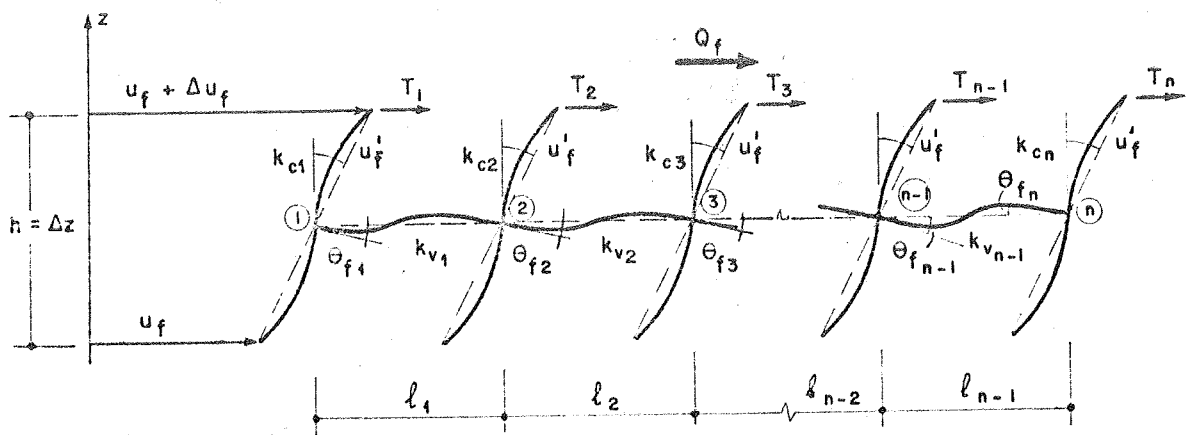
SEGMENTO DE PÓRTICO (s_f)
